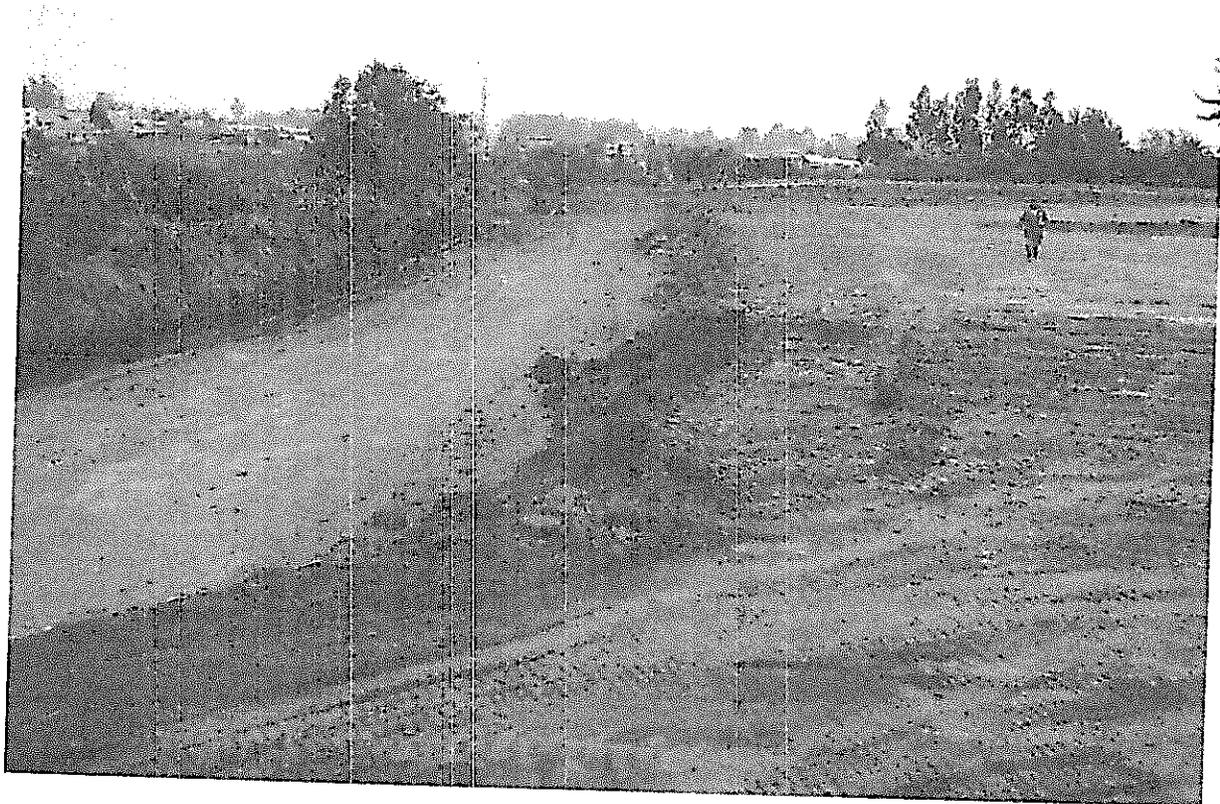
MOVIMIENTO DE TIERRA CON RESPETO DEL LINDERO ORIGINAL CON LA CALLE
